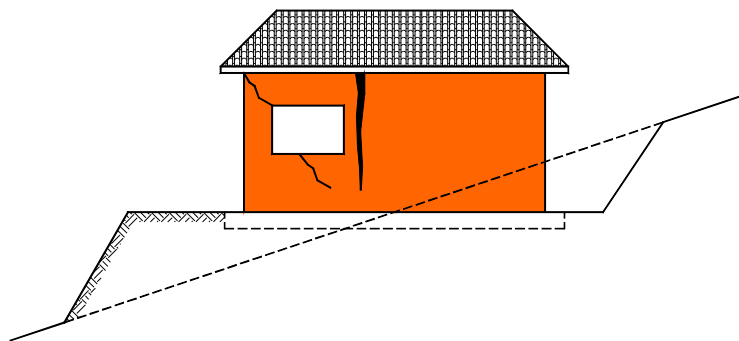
Fundações assentadas sobre seções de corte e aterro; fissuras de corte nas alvenarias [30]
